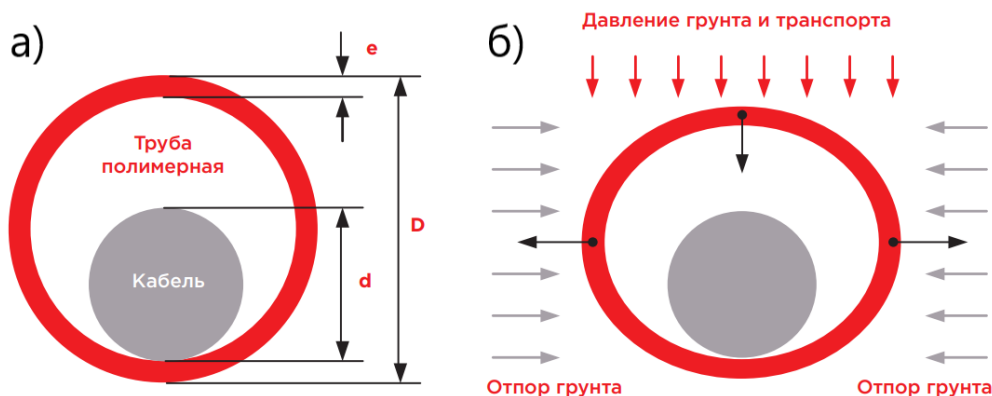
Полимерная труба с одним кабелем: без давления грунта (а), с давлением грунта (б).
